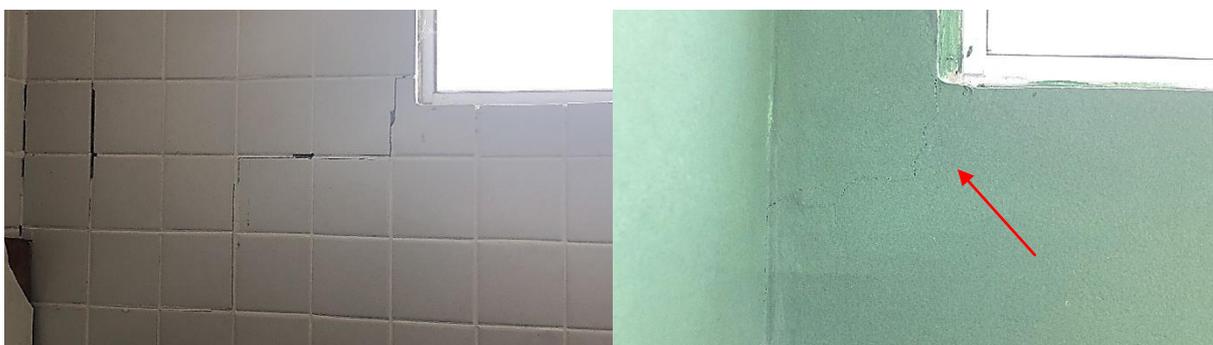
Fissuras higroscópicas nas rampas, com destacamento de revestimento em textura
